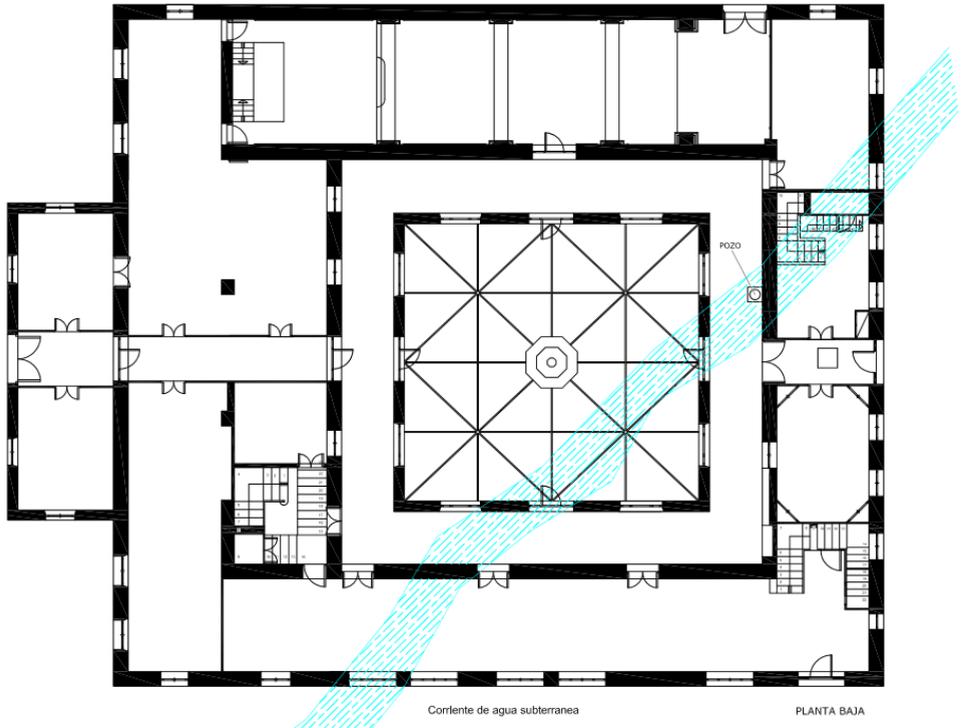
Plano de planta baja donde se muestra la corriente subterránea localizada, la cual coincide lógicamente con el antiguo pozo. 2016.
